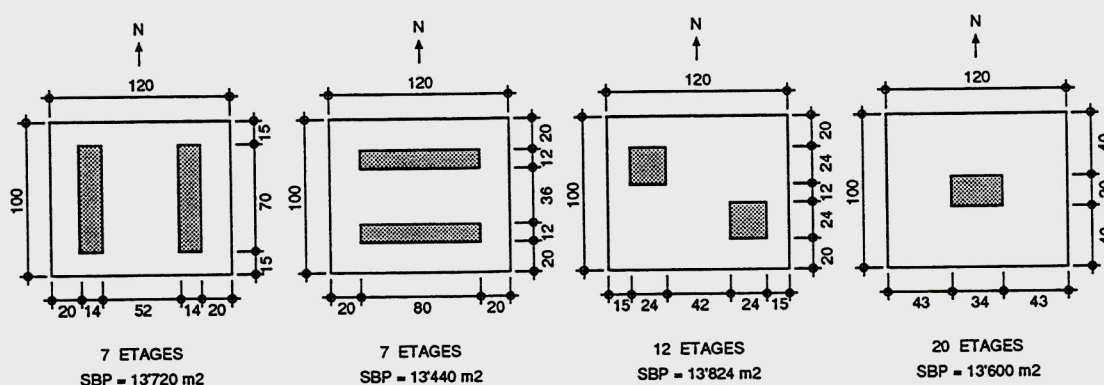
implantations à choix pour la zone 3D, Genève (toutes les dimensions sont en mètres, et SBP est la surface brute de plancher).
